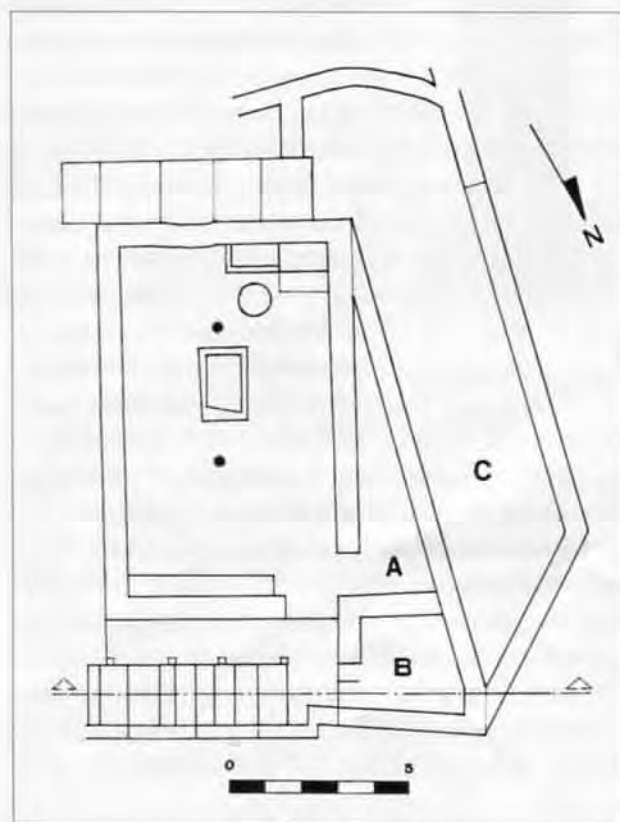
Restituzione planimetrica, secondo I. Beyer (1976).
